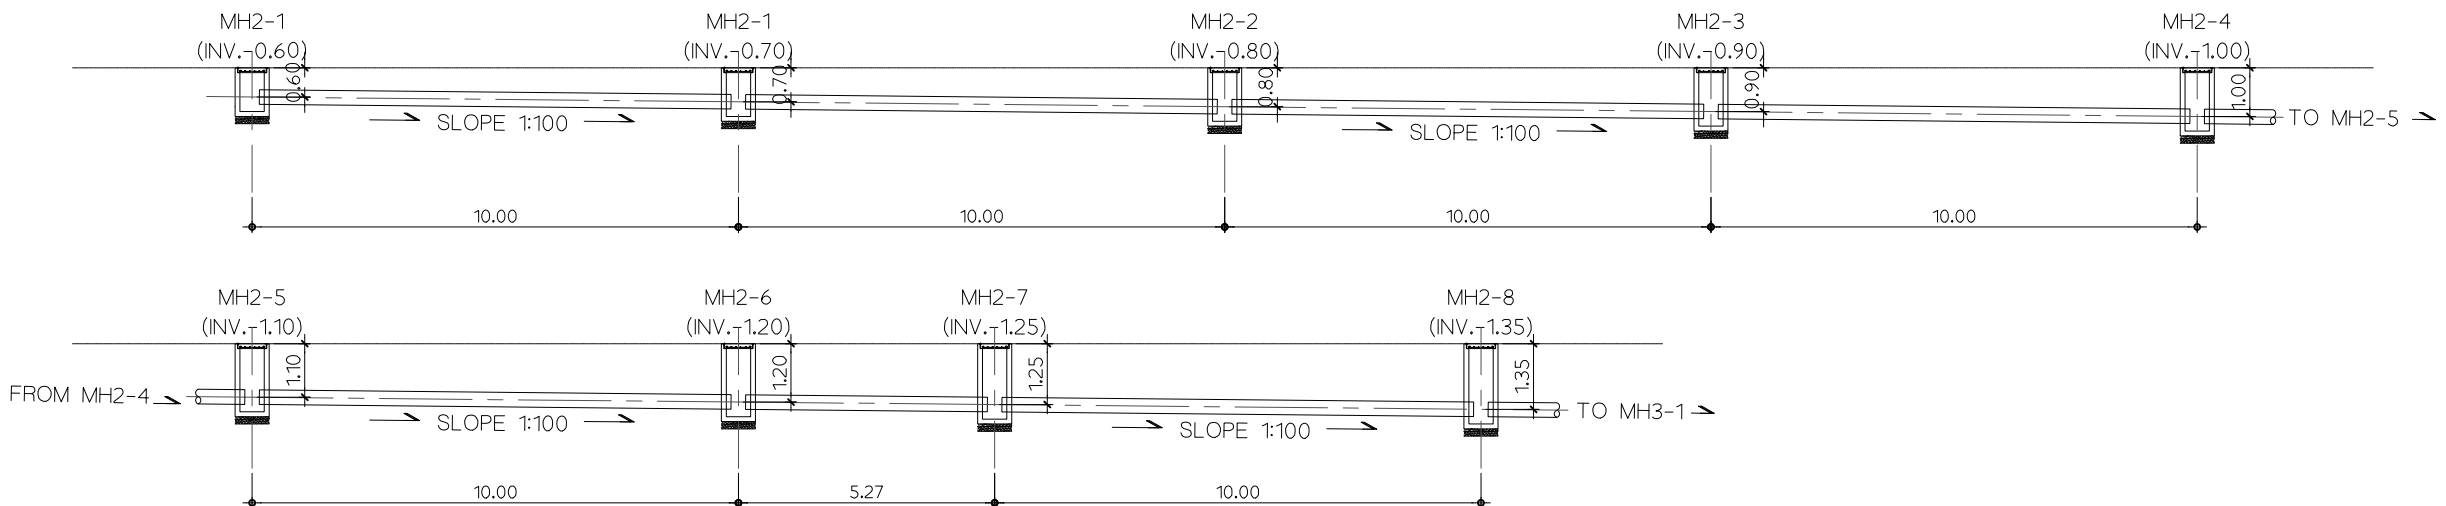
แผนผังระบบระบายน้ำของโครงการ
